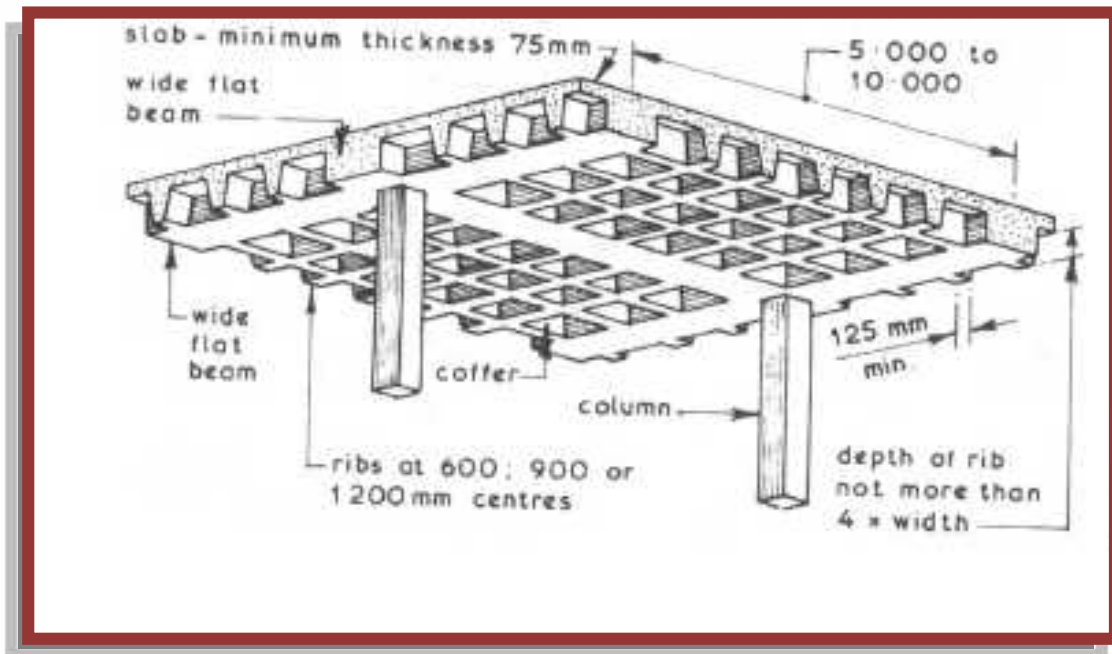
مقطع من عقدة الأعصاب
